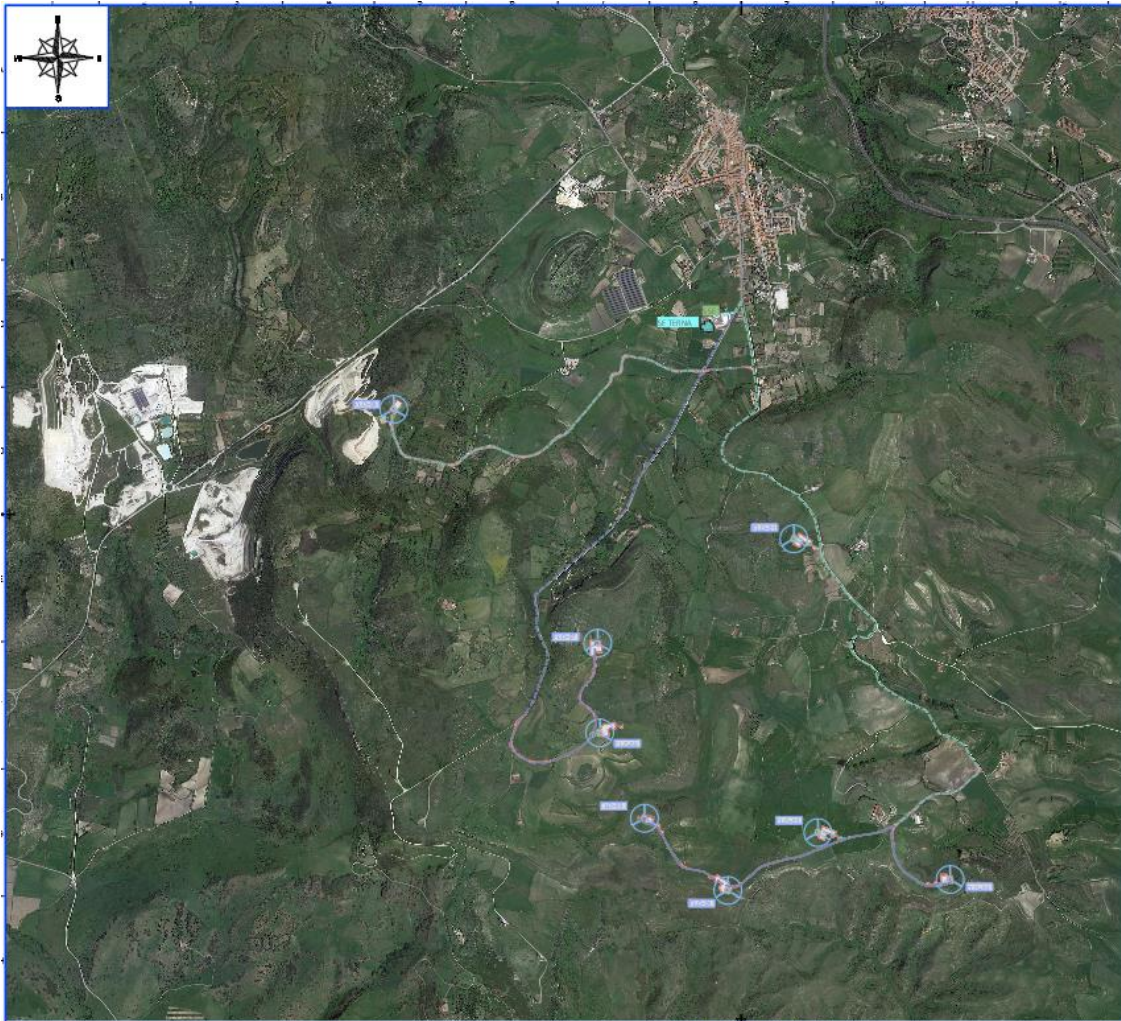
Layout dell'impianto su Ortofoto 1:10000
